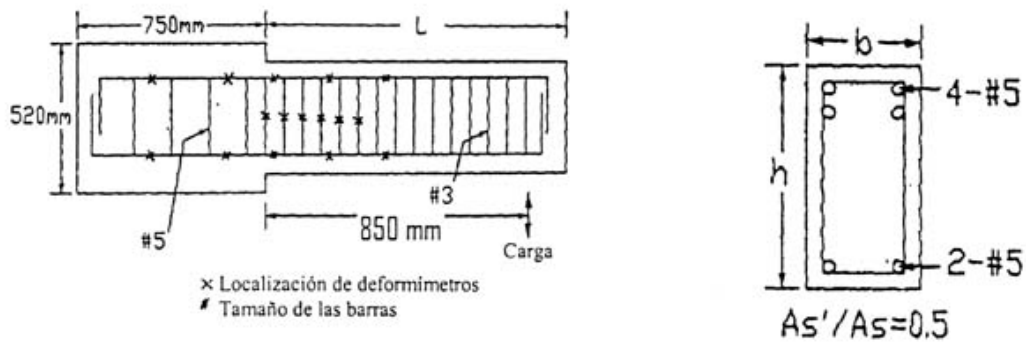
Geometría de la estructura y detalles de la sección transversal del elemento de viga del ensayo lb2-6 realizado por Fang et. al. [46]
